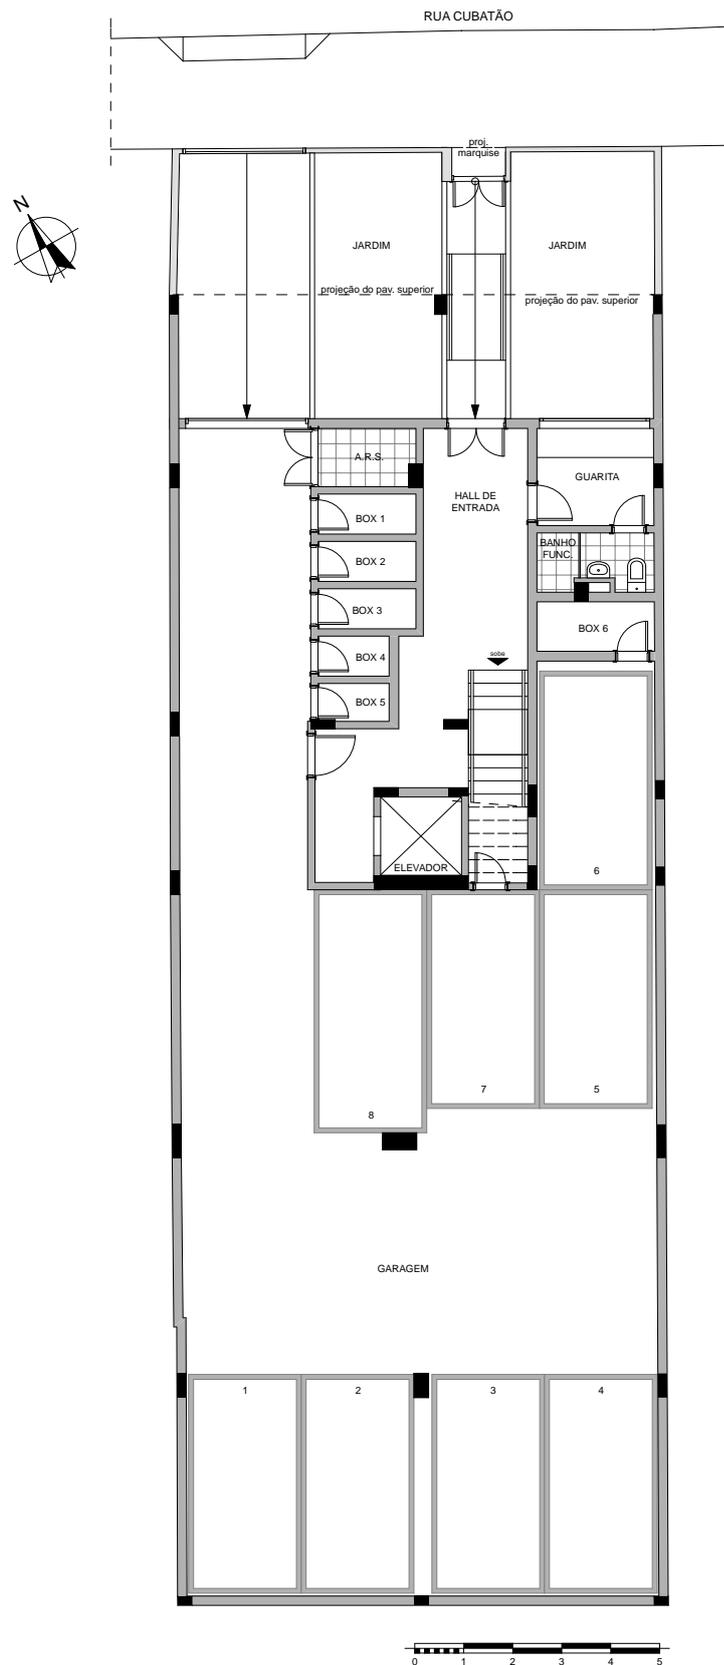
Planta pavimento térreo (Fonte: Autora, 2016)
